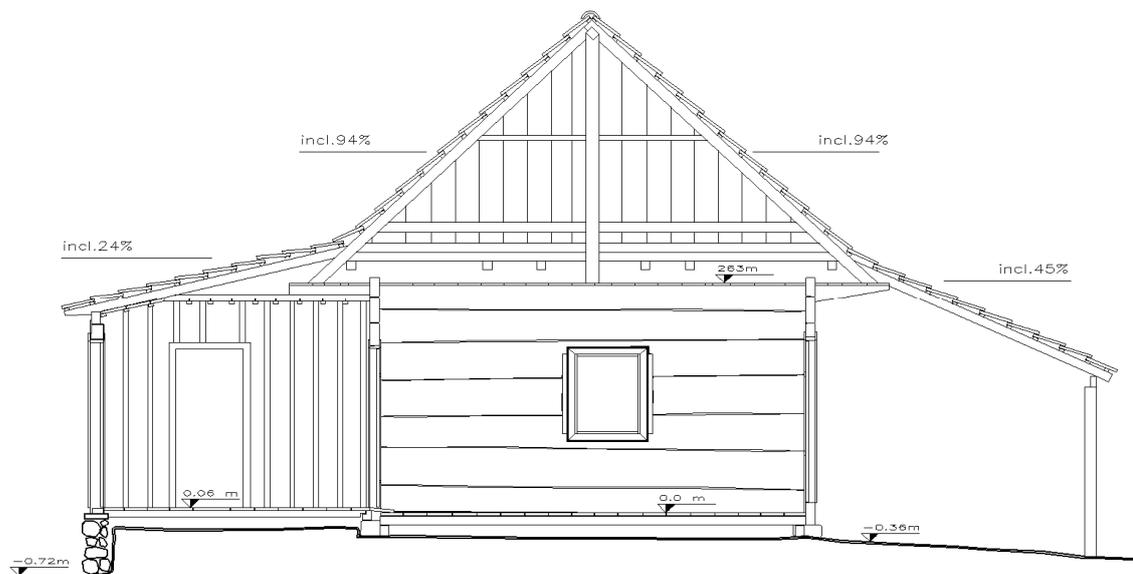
CORTE TRANSVERSAL, TELHADOS E INCLINAÇÕES
